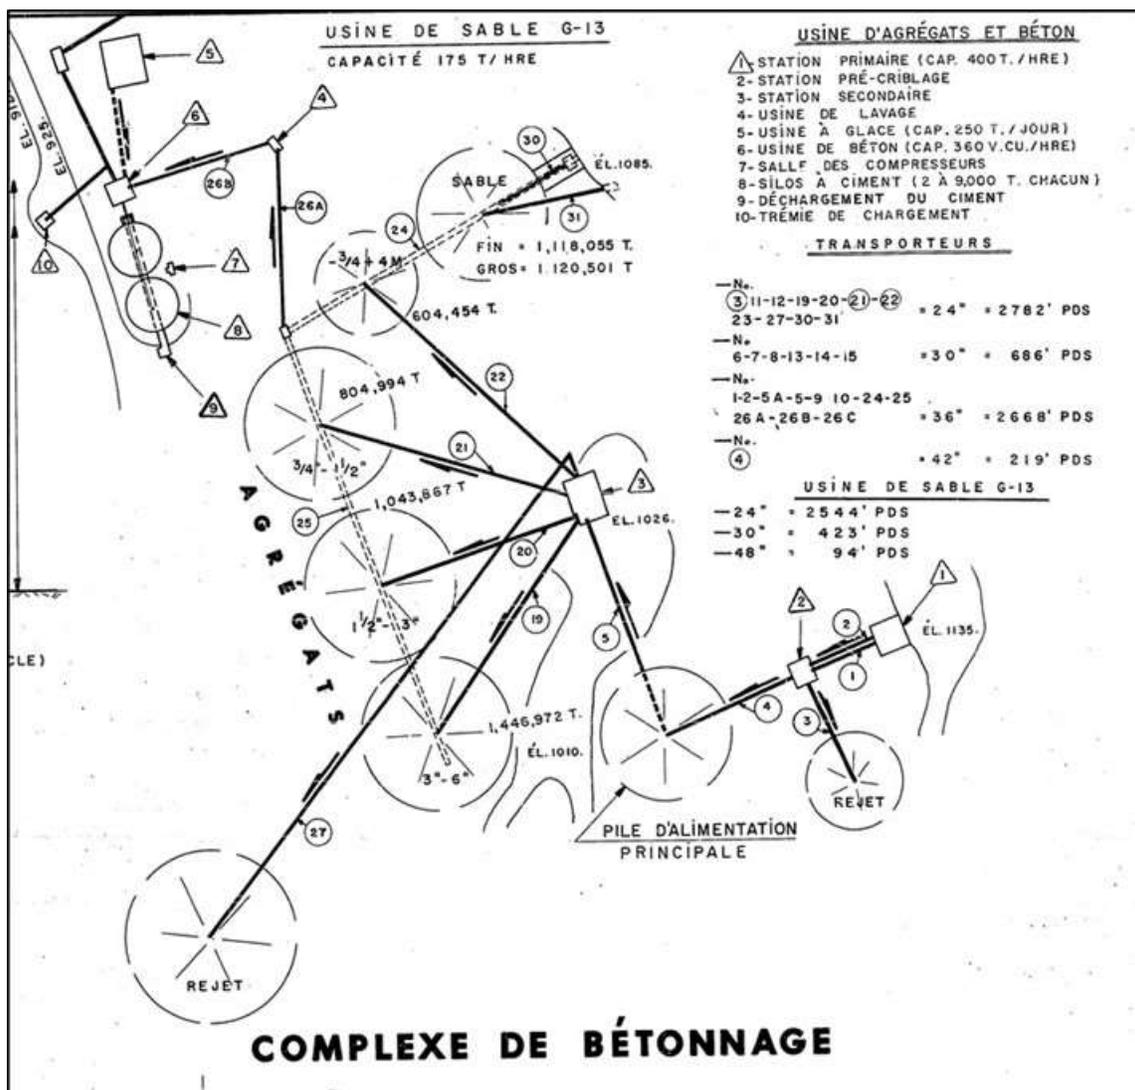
Détail du complexe de bétonnage. (Source : Hydro-Québec, Manicouagan 5, Travaux temporaires, Plan d'ensemble et détails, 23 janvier 1968, 0016-70309-002-01-0-PH-F.T01.)
